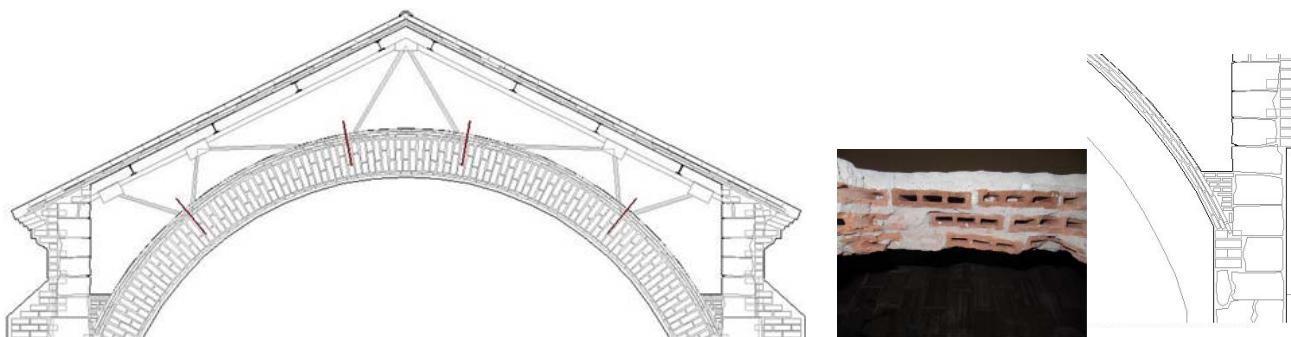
Celosía y correas metálicas como soporte de cubierta. Steel truss and purlins supporting the roof. Fig. 22. Cala en bóveda tabicada. Cutaway in timbrel vault. Fig. 23. Arranque de la bóveda. Vault springing.
